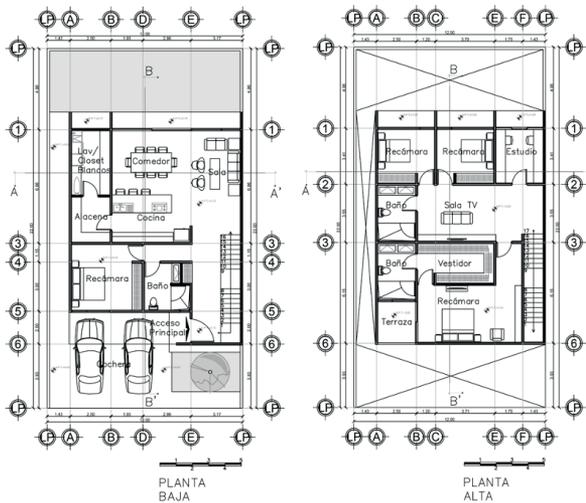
Planta baja y Planta alta del proyecto arquitectónico. S/E. Fuente: Elaboración propia (2024)
